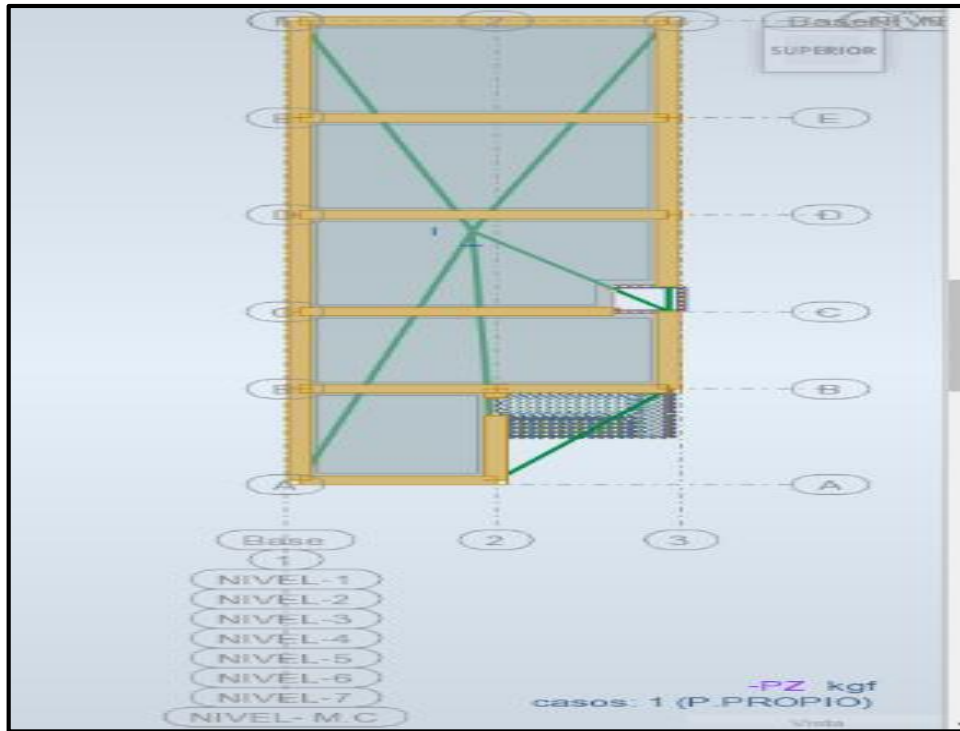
Vista en planta del modelo estructural del edificio en el programa BIM. Autodesk robot estructural. Fuente propia.
